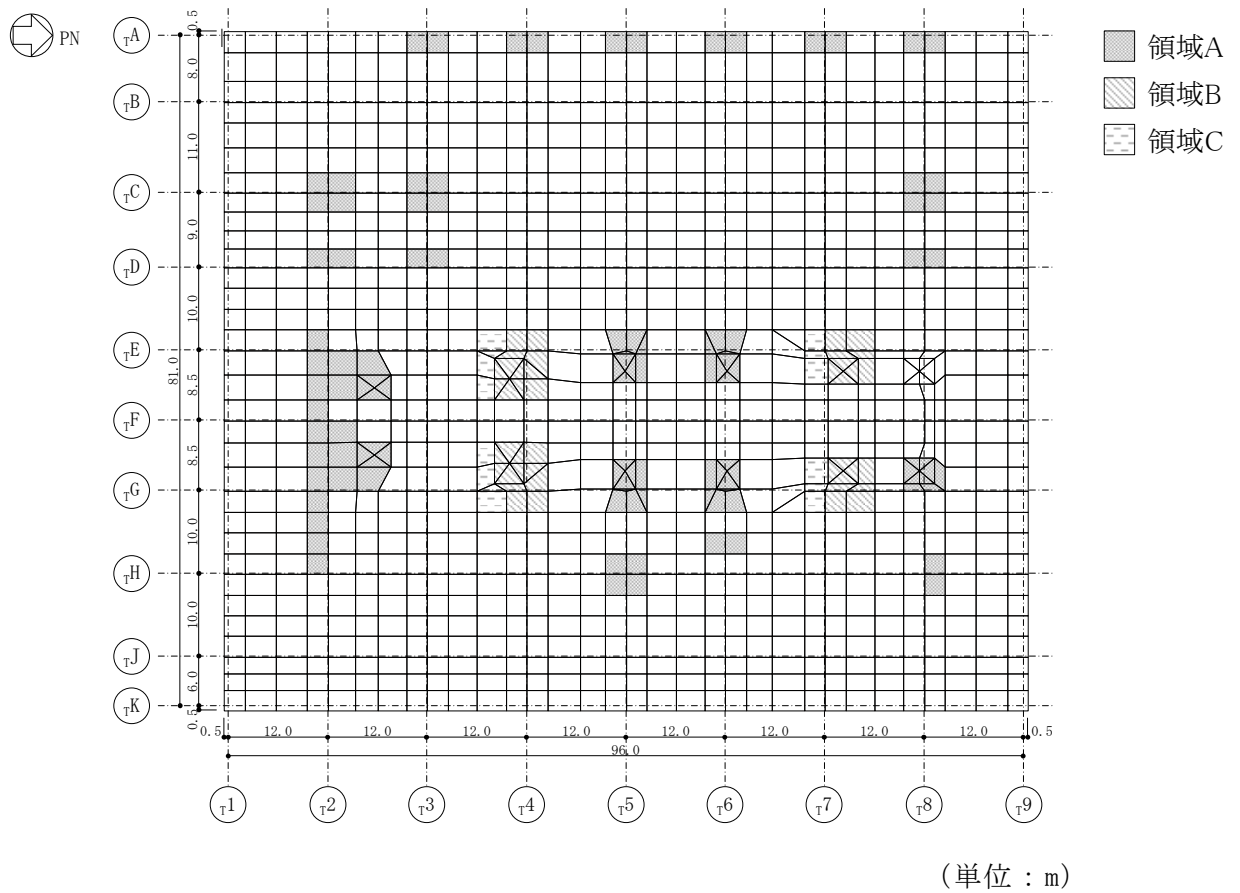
基礎スラブの配筋領域図（せん断補強筋）
